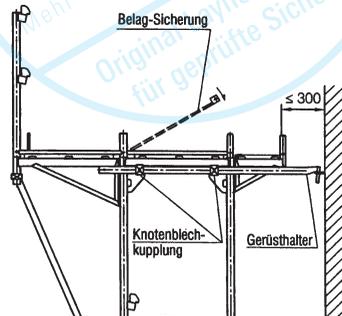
Gerüsthalter (Euro-Stellrahmen)
